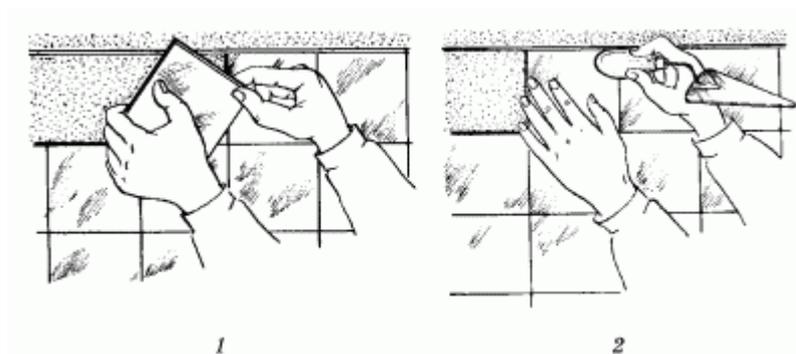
Укладка плитки на стене: 1 – установка плитки; 2 – осаживание плитки.
